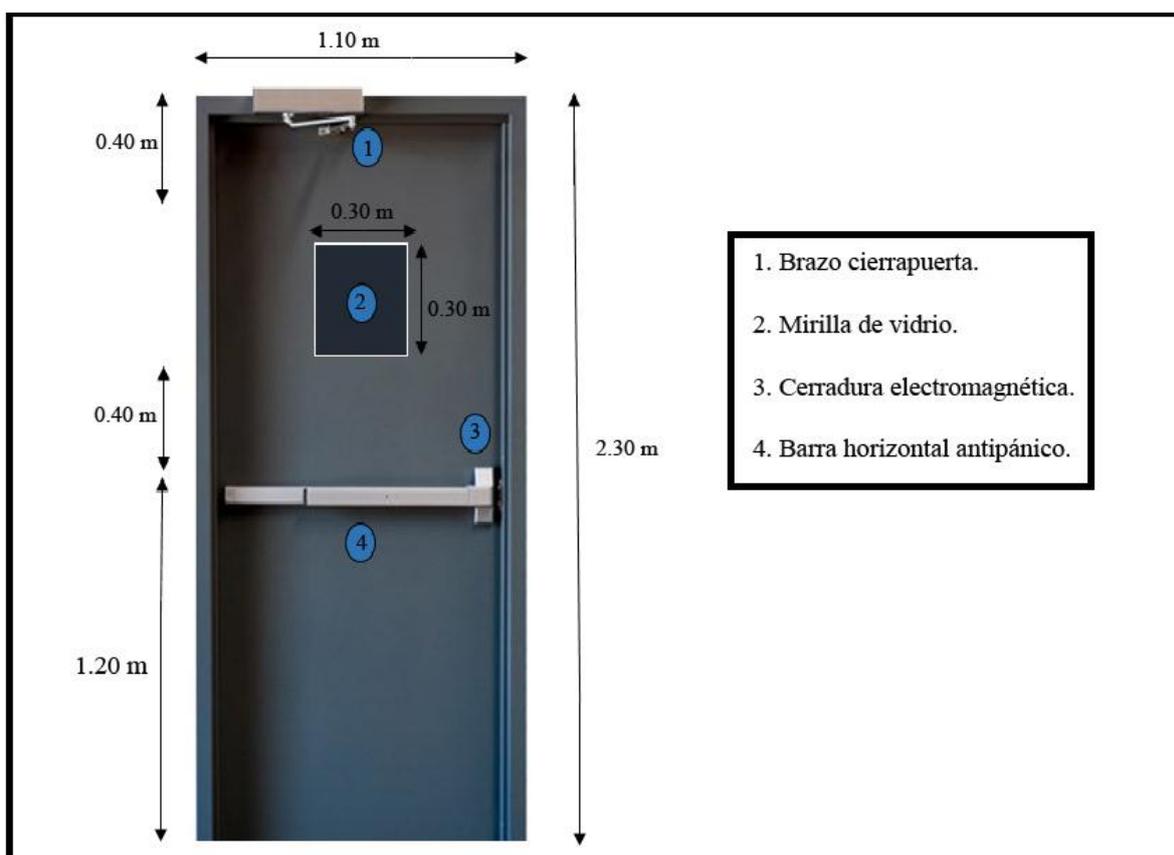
Puerta acceso Data Center (Anexos B⁶⁴)
